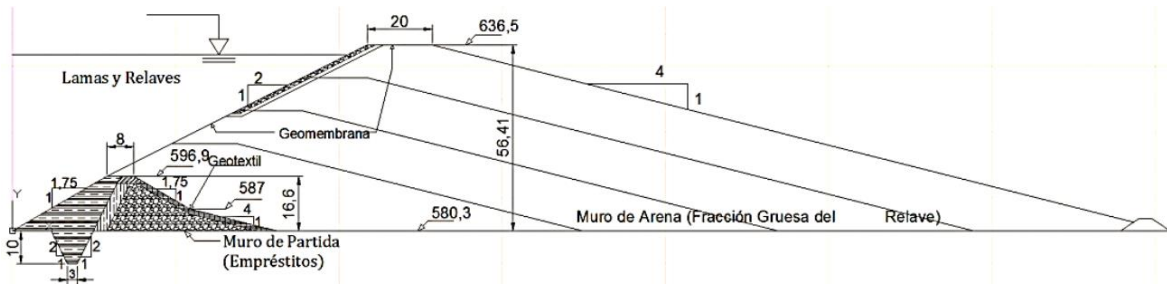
Geometría sección transversal, Muro Principal. Fuente: [79].
